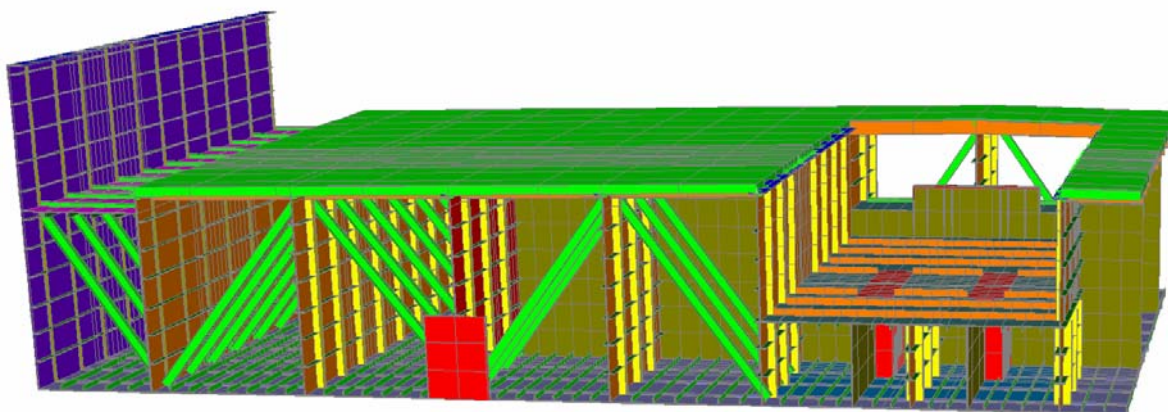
Vista isometrica - Layout del cassone in acciaio
